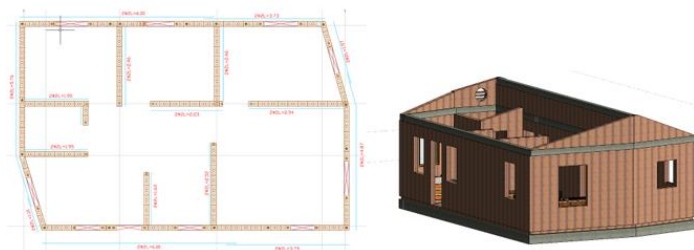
Diseño estructural en muro BTC reforzado para VISS_2.
